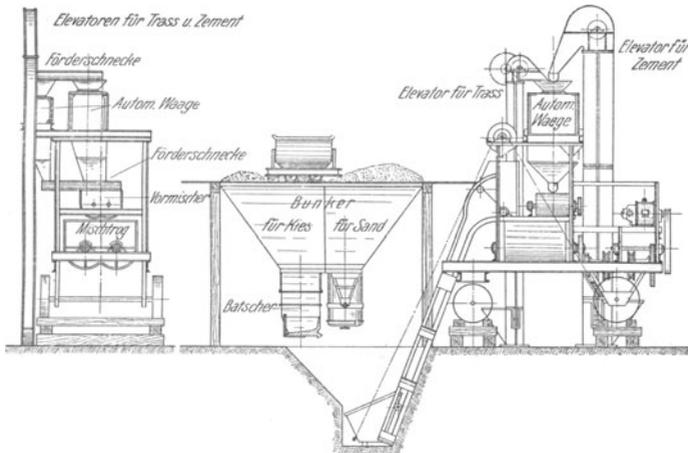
b. Schemazeichnung der Betonbereitungsanlage in Abb. 72 a
